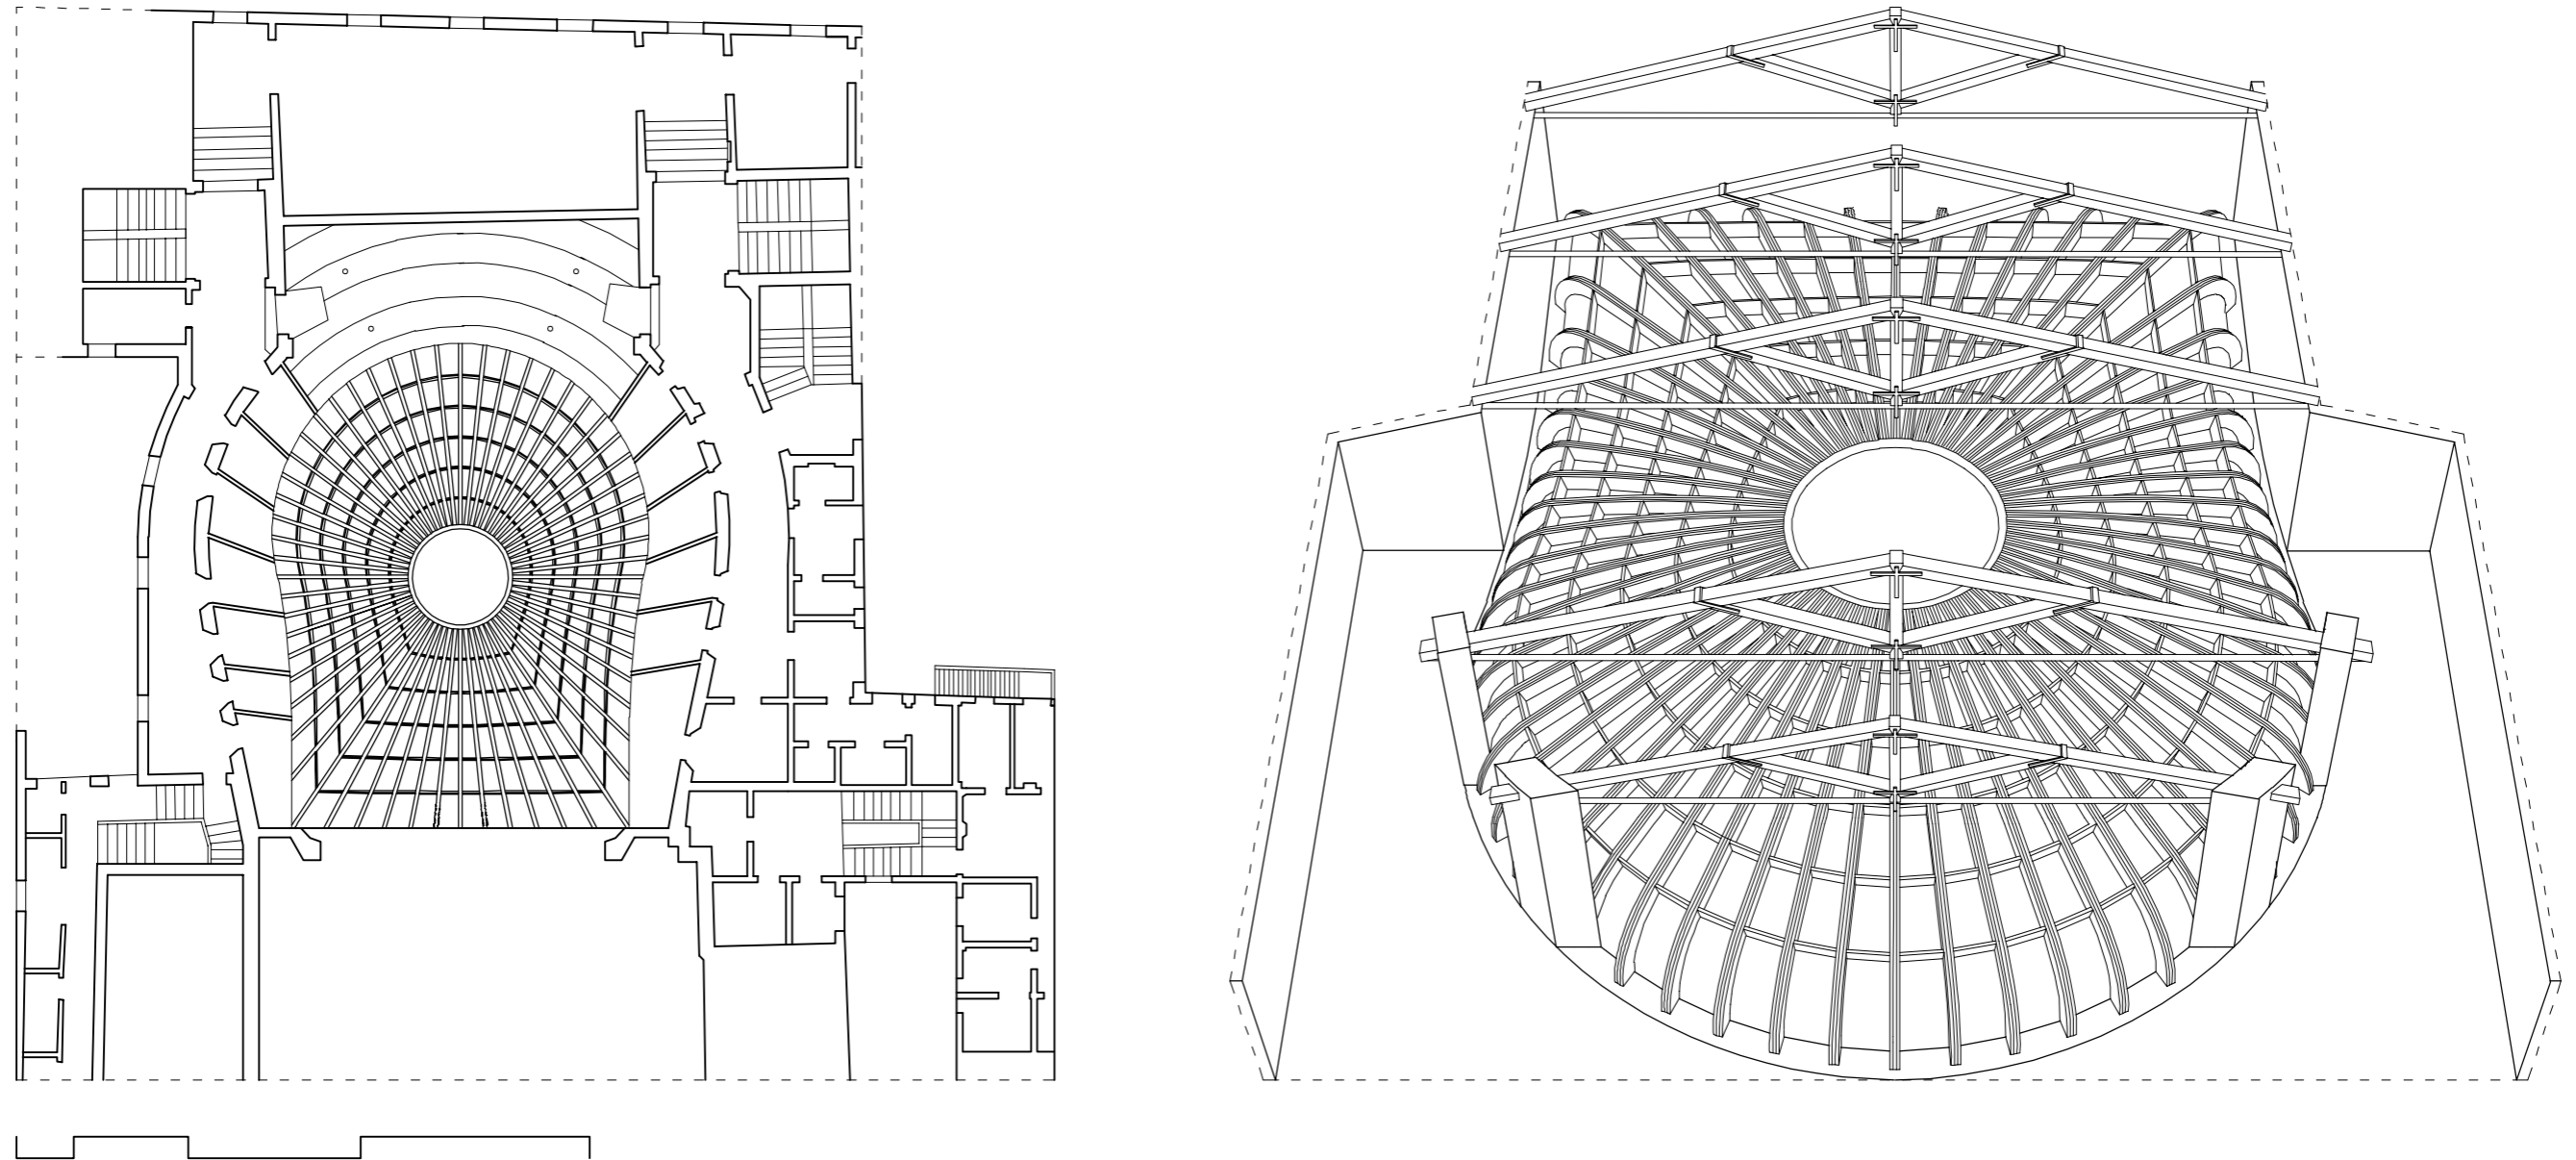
Teatro Consorziale di Budrio. Pianta del primo ordine di palchi (ridisegno) con proiezione del plafone; rappresentazione prospettica del sistema di copertura della sala.
